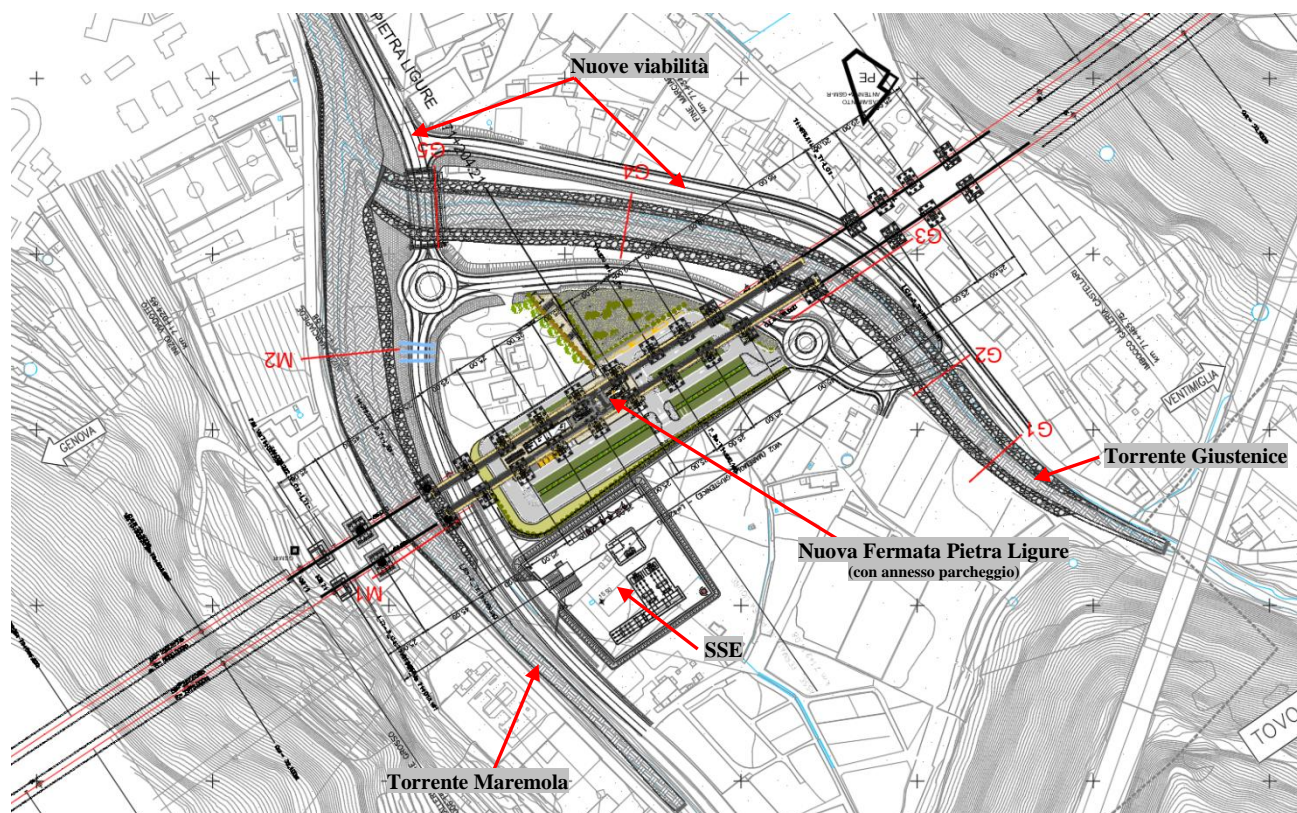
Stralcio della planimetria di progetto in quel di Pietra Ligure.
